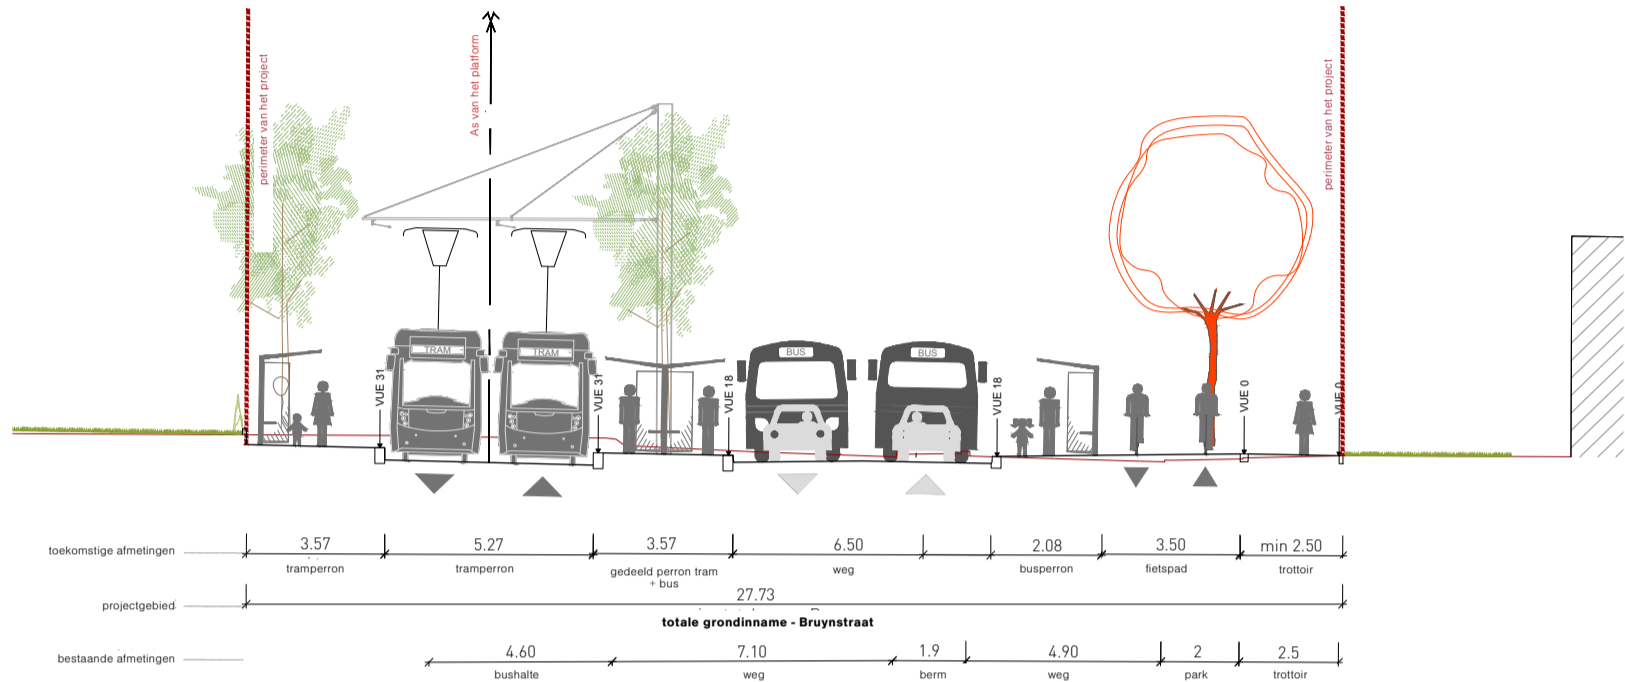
Secteur 7 - Avenue de Tyras - Coupe 3
